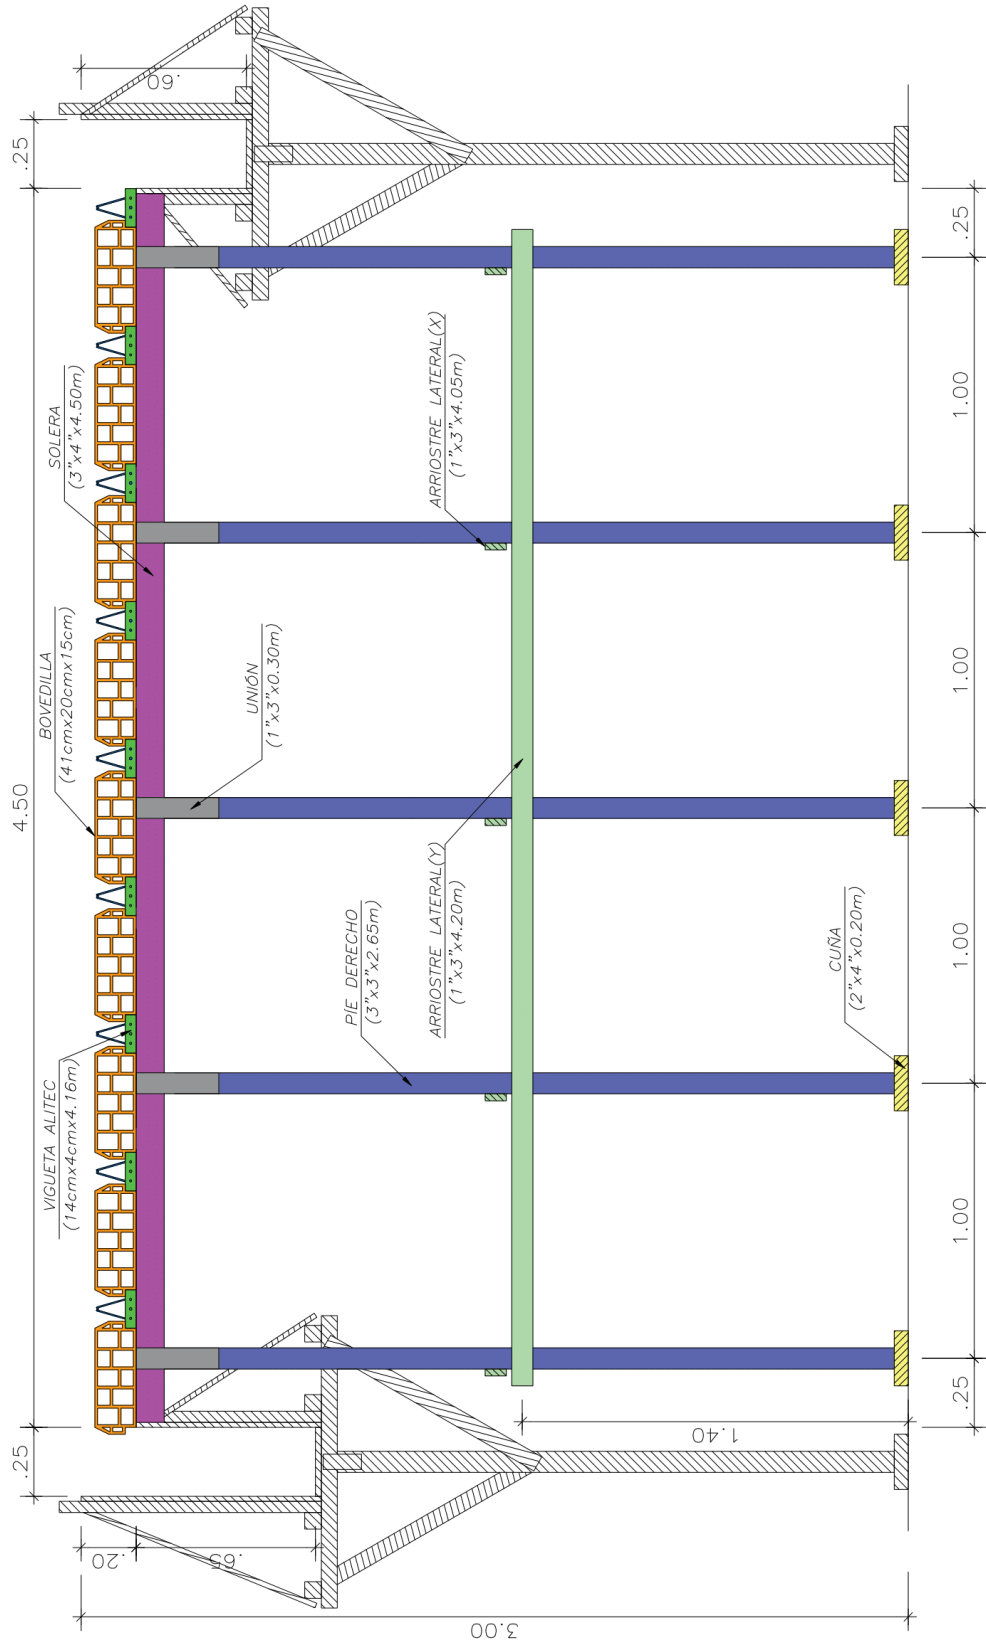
Corte Longitudinal B – B, para la Losa Aligerada Unidireccional Prefabricada Alitec.
